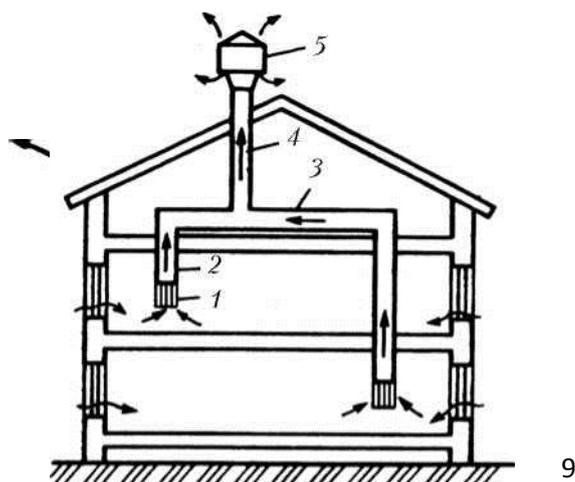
Схема естественной вытяжной канальной вентиляции:
